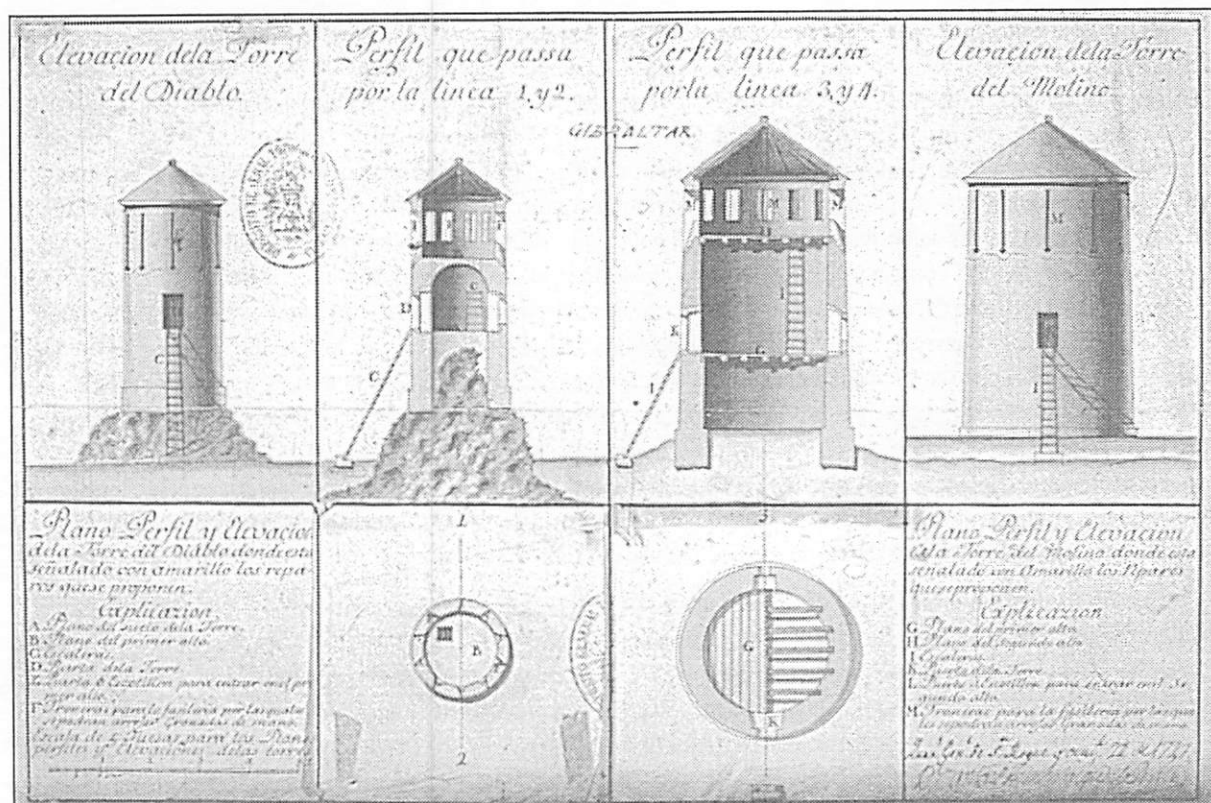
Plano, Perfil y Elevación de la Torre del Diablo donde está señalado con amarillo los reparos que se proponen. Explicación. A. Plano del suelo de la Torre. B. Plano del primer alto. C. Escaleras. D. Puerta de la Torre. E. Puerta o Escotillón para entrar en el primer alto. F. Troneras para la fusilería por las cuales se podrán arrojar Granadas de mano. Escala de 5 Tuestas para los Planos, perfiles y Elevaciones de las torre. Plano, Perfil y Elevación de la Torre del Molino donde está señalado con amarillo los reparos que se proponen. Explicación. G. Plano del primer alto. H. Plano del segundo alto. I. Escaleras. K. Puerta de la Torre. L. Puerta o Escotillón para entrar en el segundo alto. M. Troneras para fusilería por las cuales se podrán arrojar Granadas de mano. Escala de 5 Tuestas para los Planos, perfiles y Elevaciones de las torres. Cuartel General de San Roque y octubre, 22 de 1727. Don Antonio de Montaignu de la Perill. S. H. M. Doctº nº 2830, B-6-3, San Roque, 22 de octubre de 1727
